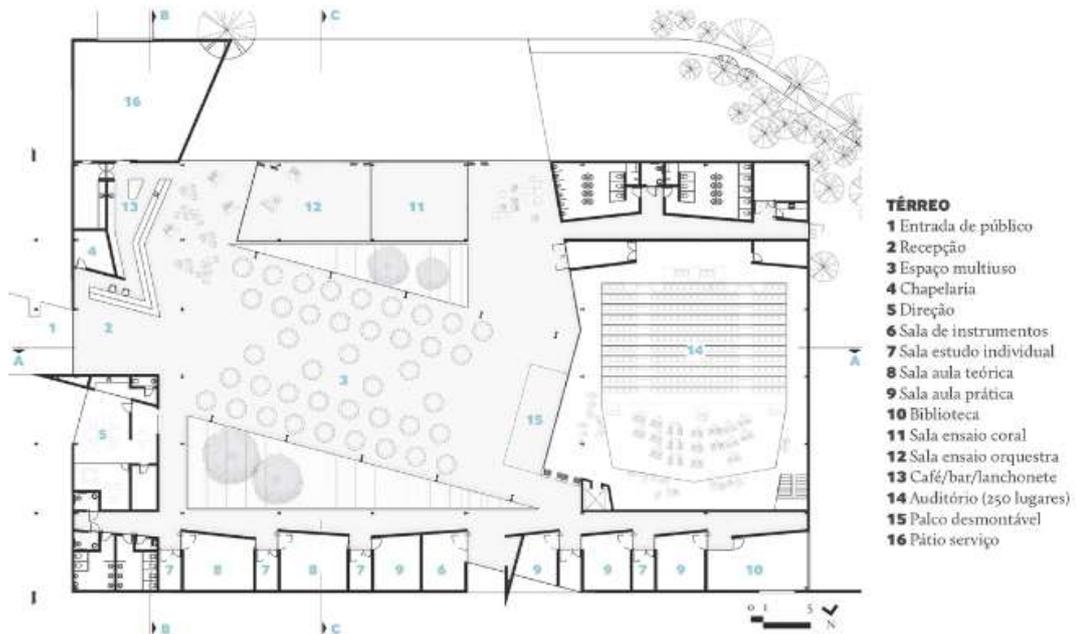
Planta baixa Pavimento 1. Escola de Música Tohogakuen.
